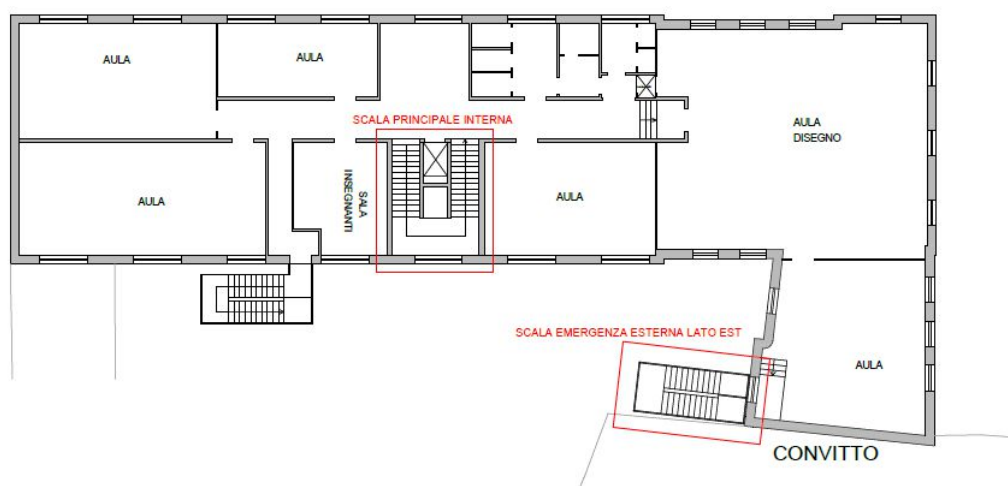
Pianta piano tipo del Padiglione Meccanica con individuazione dei corpi scala oggetto d'intervento.
